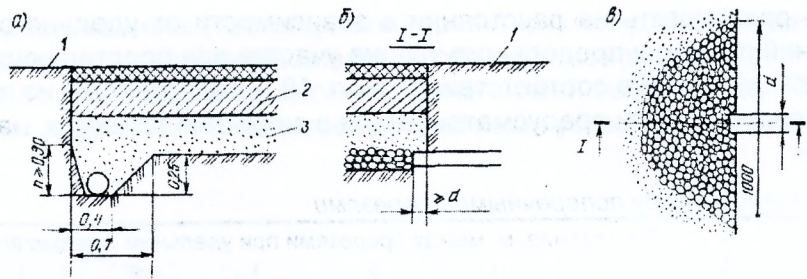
Дренажные трубы для осушения песчаного основания: а – продольная дрена; б – поперечная дрена; в – поперечная дрена в плане; 1 – обочина; 2 – дорожная одежда; 3 – песчаное основание
